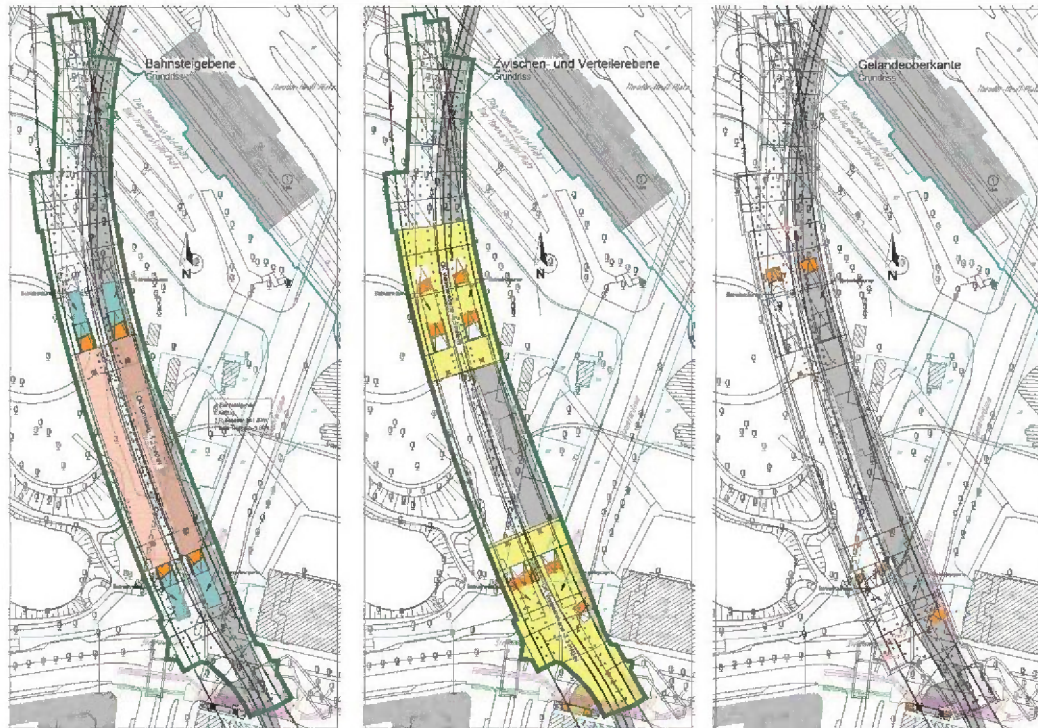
Lageplan Haltestelle Stephansplatz IV
